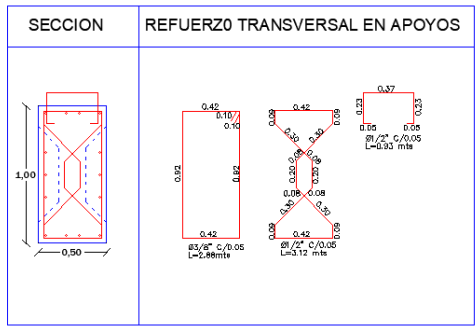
Sección transversal de las vigas de un puente en concreto postensado de 12 metros. (ver anexo 03 página 03 y 04)
